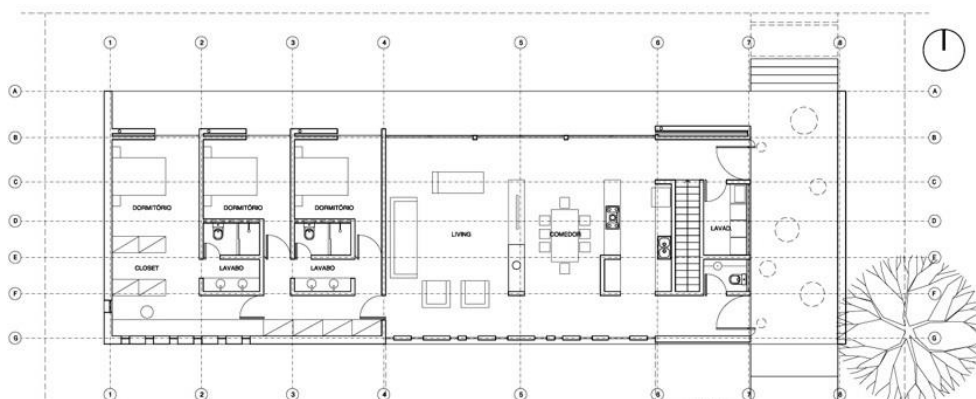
Planta da Casa Bertolini – Studio Paralelo
